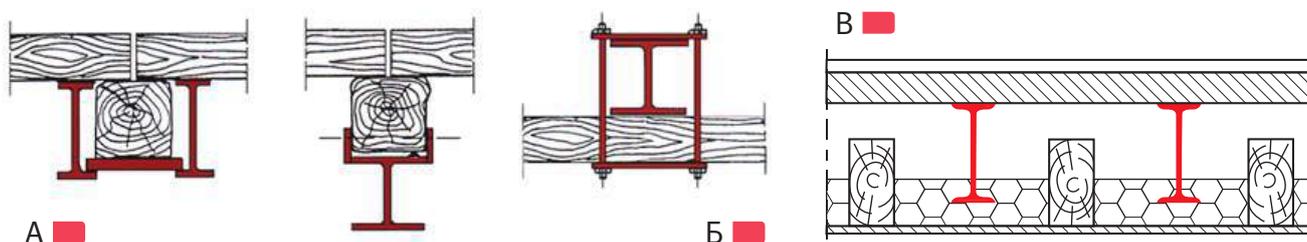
Усиление деревянных перекрытий изменением конструктивной схемы: А – балок – путем подведения стальных элементов; Б – настилов – подвешиванием к металлическим двутаврам снизу; В – обустройство независимого перекрытия между деревянными балками
